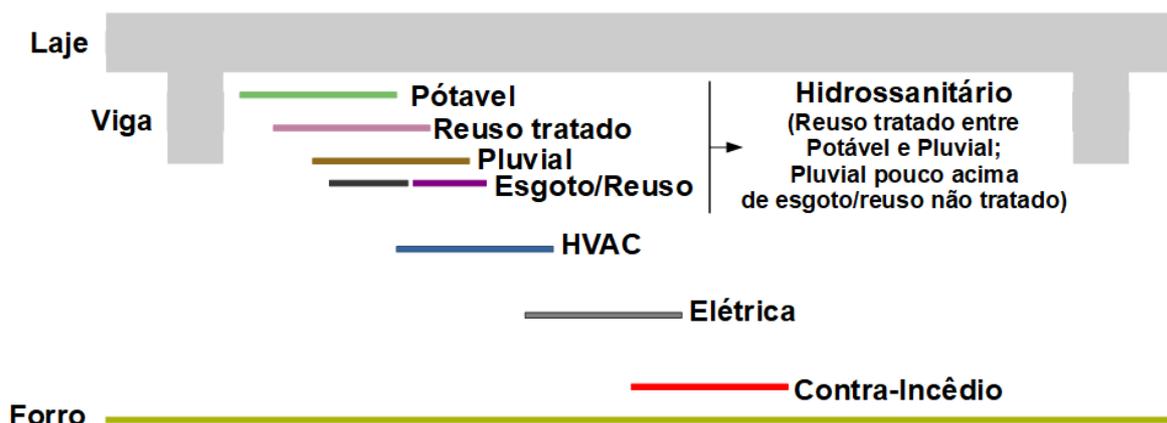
Esquema 1 - Níveis de Trabalho - Entreforço – Vigas
